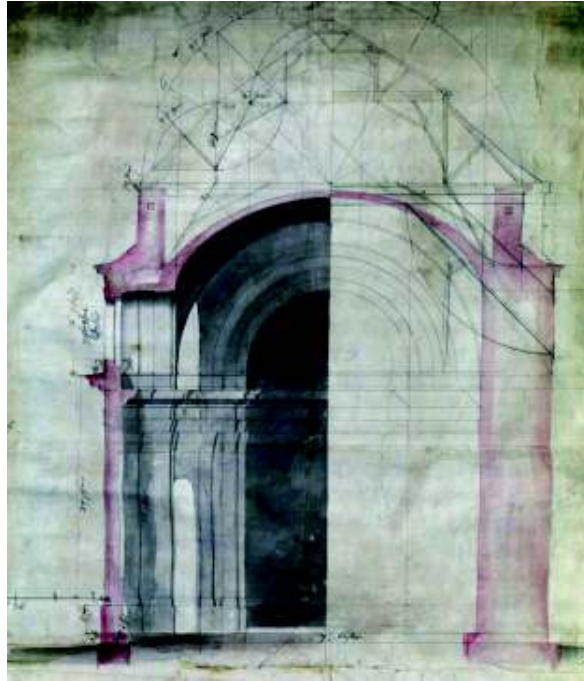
Plan original (înainte de 1769) – secțiune transversală al bisericii piariste din Carei [74:23.kép]
